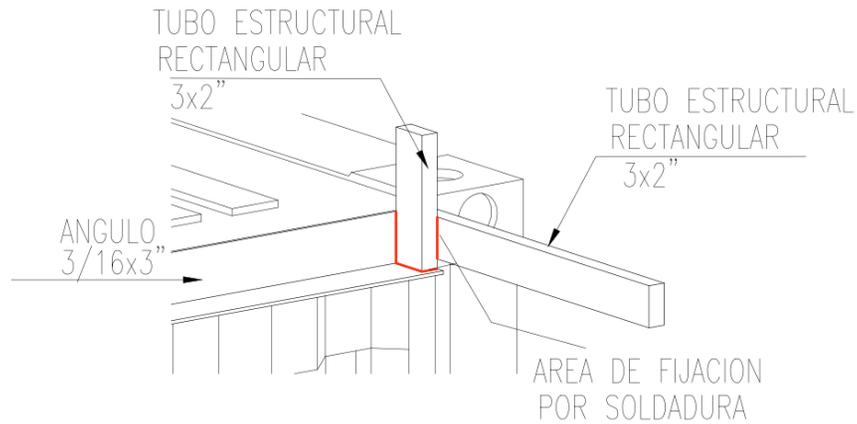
Vista en Conjunto de Tubo Estructural con Angulo de 3x2"
